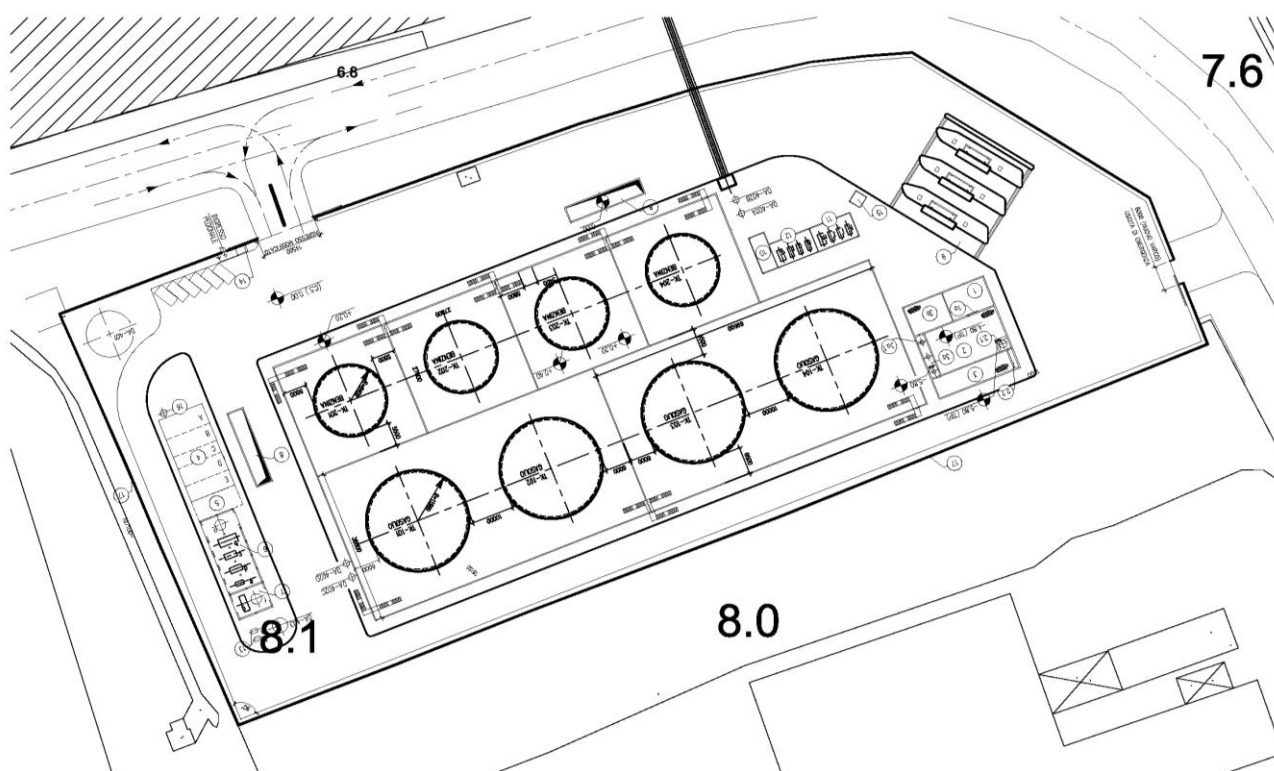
LAYOUT DI PROGETTO DEL DEPOSITO COSTIERO
